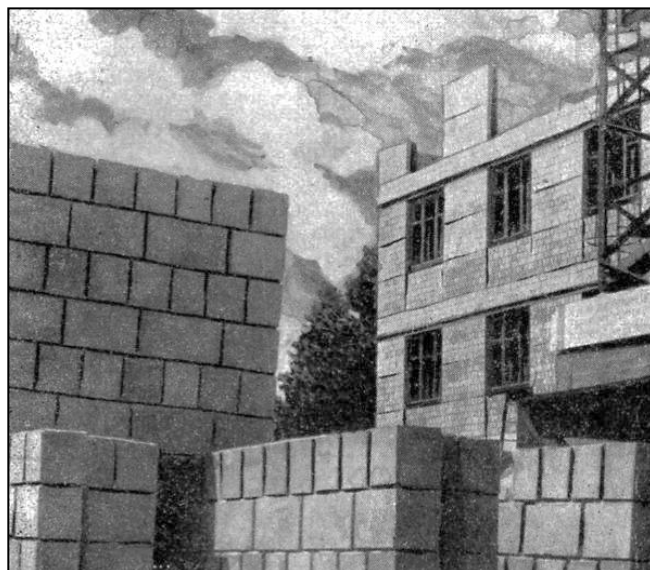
Здание из крупных стеновых блоков кирпичной кладки.
